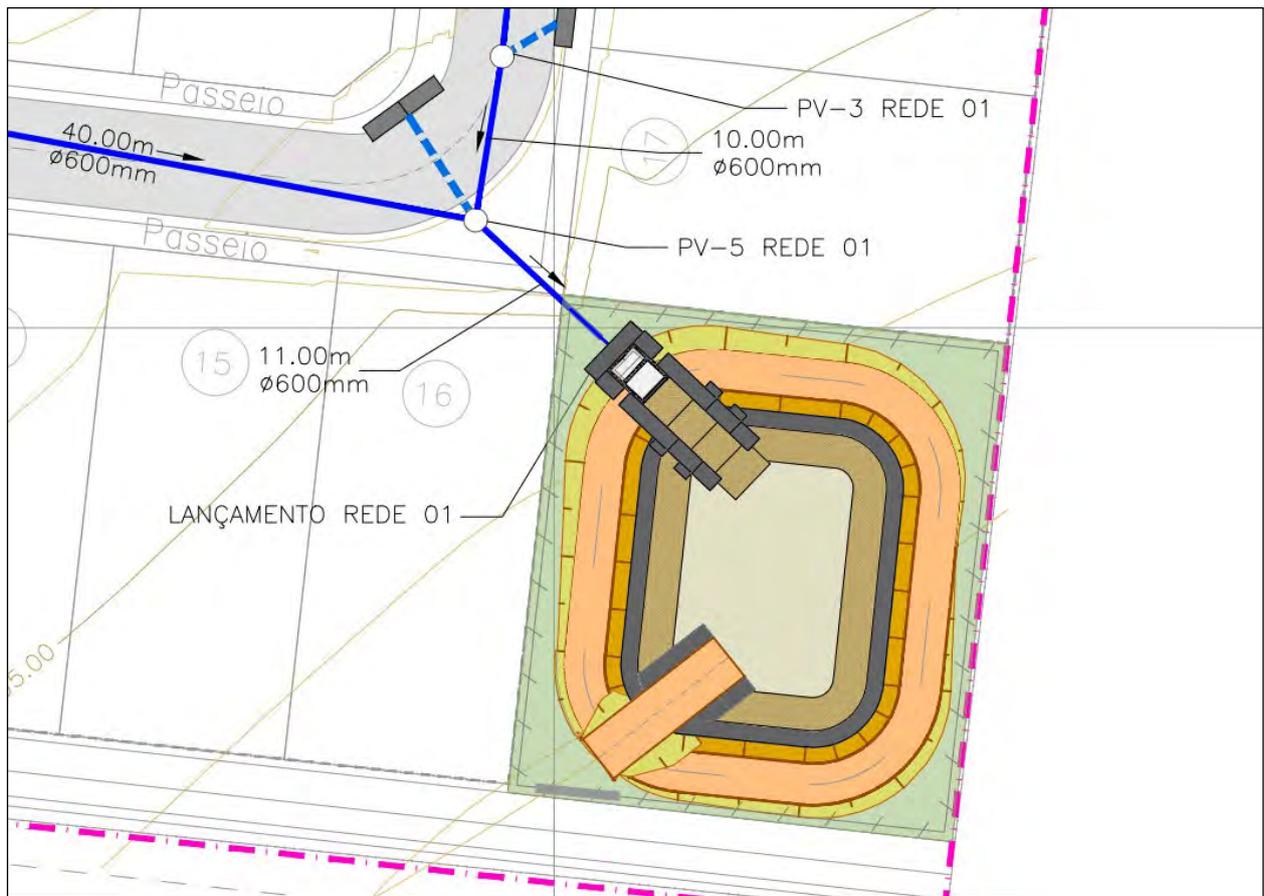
Recorte da planta do reservatório. Fonte: Autor.
